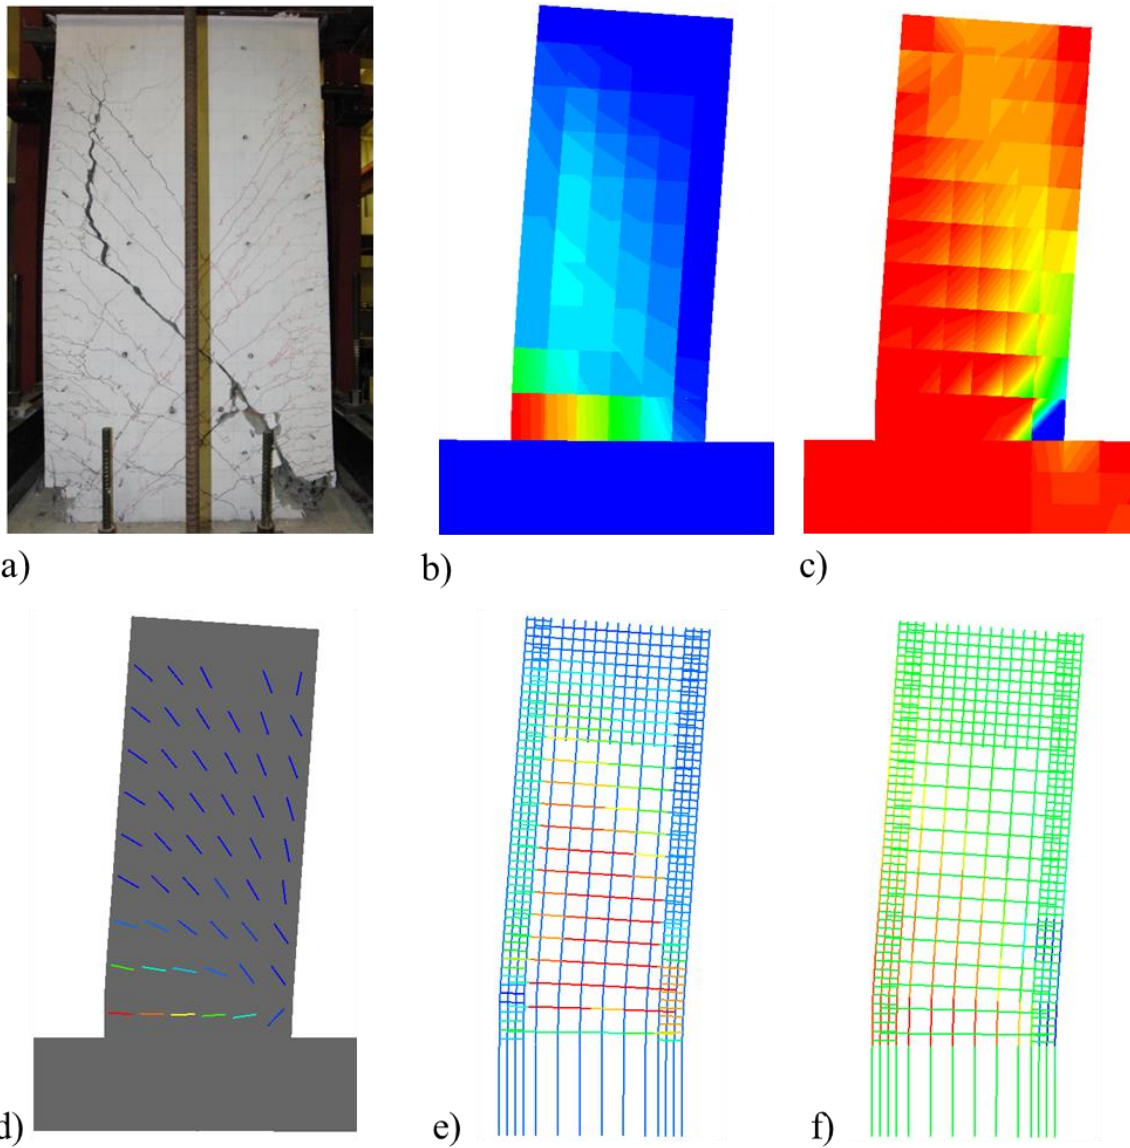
Comparación del estado de esfuerzos en el muro C cerca del punto de falla, a) Patrones de fisuración durante el ensayo al momento de la falla, b) deformaciones principales de tensión en el concreto, c) esfuerzos principales de compresión en el concreto, d) patrones de fisuración estimados, e) esfuerzos axiales en el refuerzo horizontal y f) esfuerzos axiales en el refuerzo vertical
